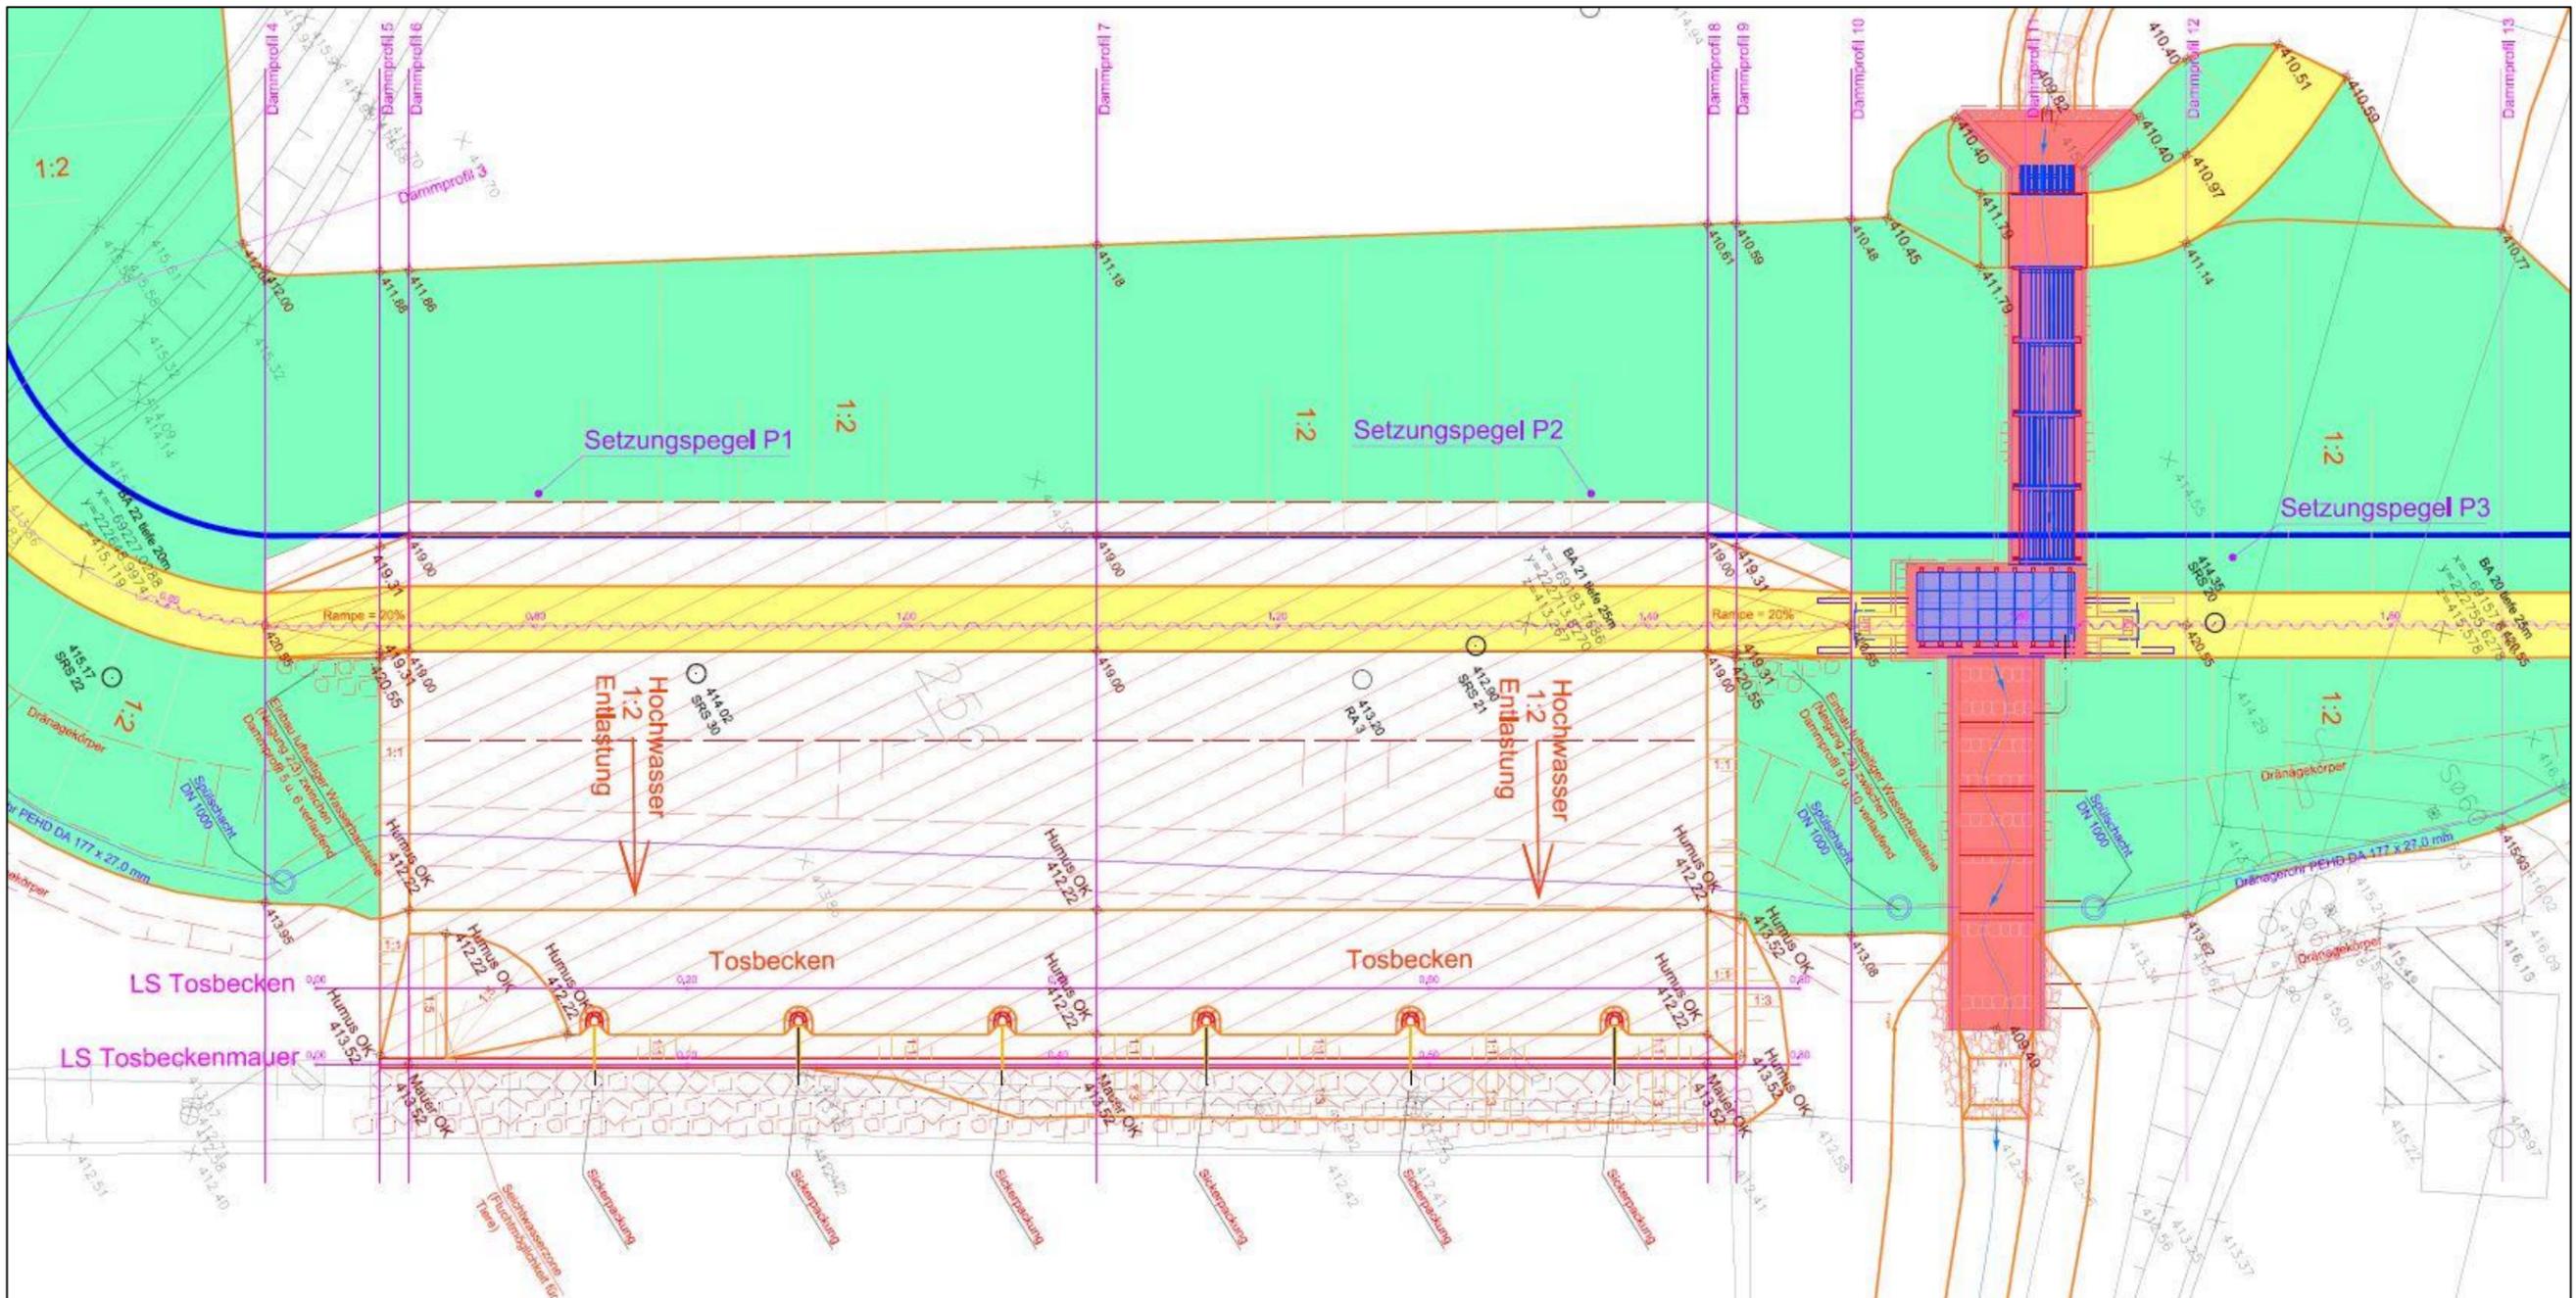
Ausschnitt aus „Lageplan RHB Andritzbach“ [Q8]
